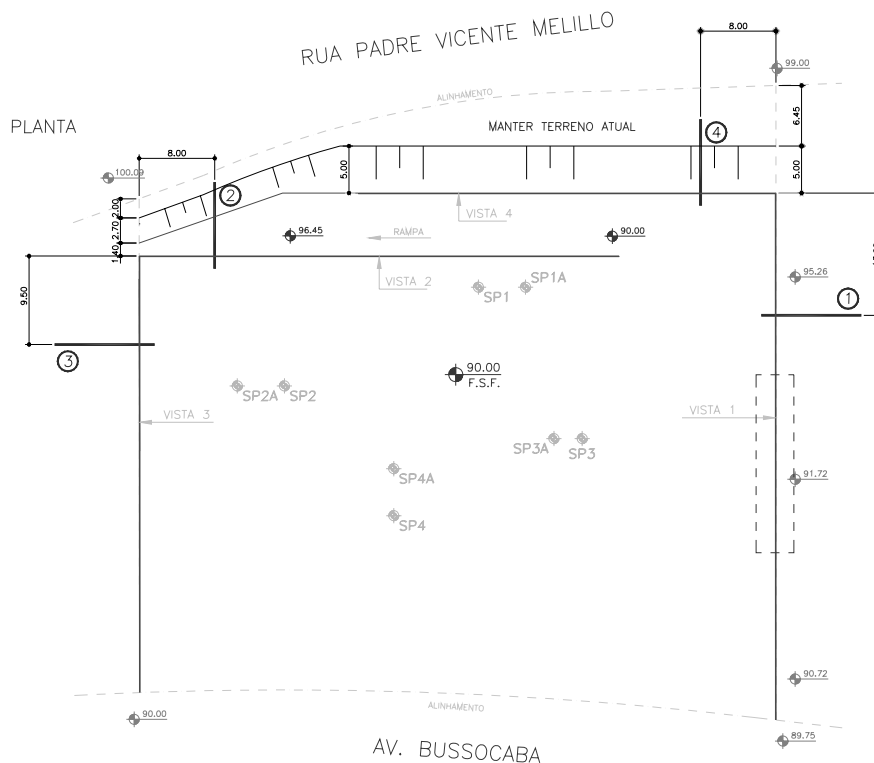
Vista em planta da obra, com destaque para a área de estudo.
